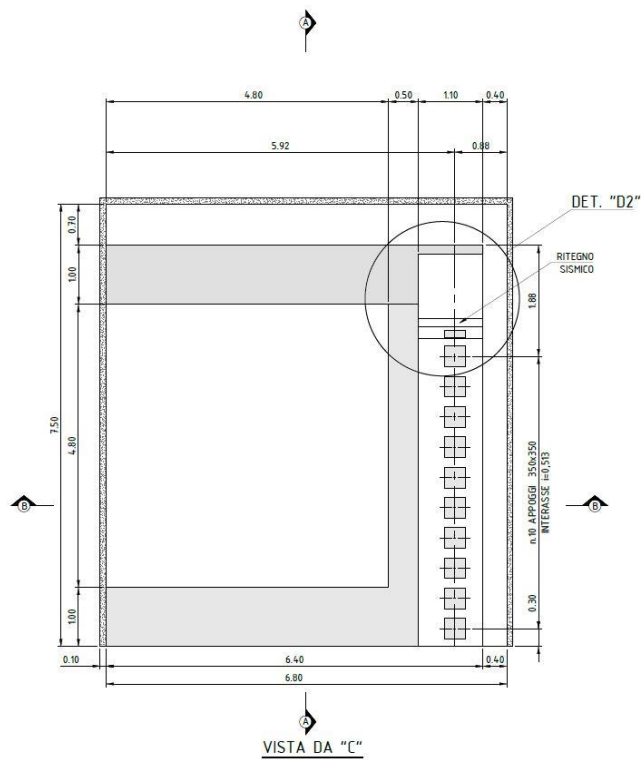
Vista in pianta della spalla (piano degli appoggi)
